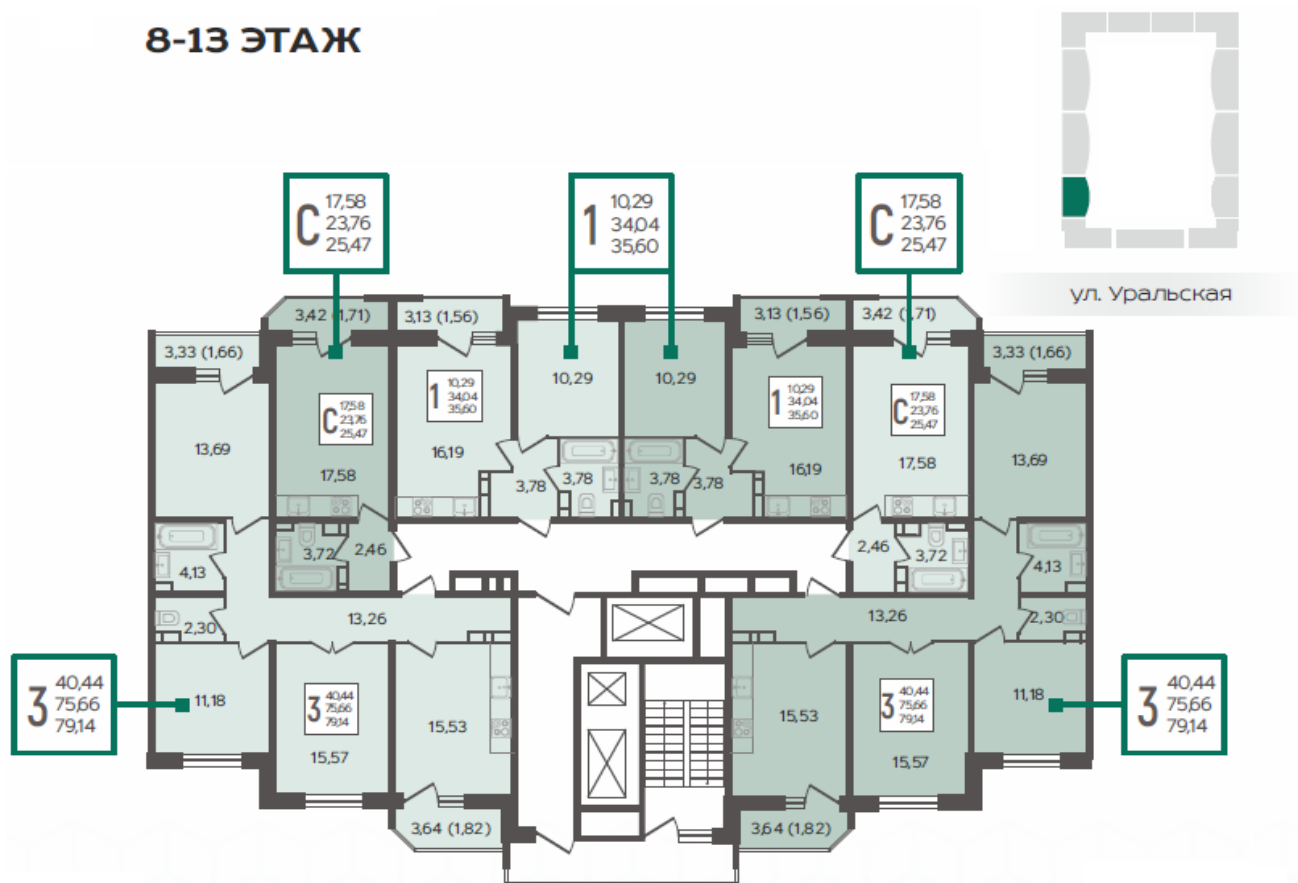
Типовой план 8-13 этажа БС-2 ЖК URAL
